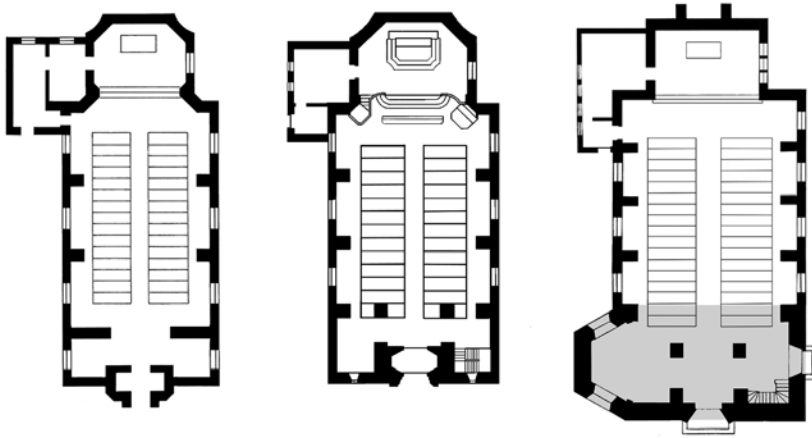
c: Grundrisse: Wiemeringhausen, St. Antonius, 1922 / Eikeloh, St. Johannes Baptist, 1924-25 / Amecke, St. Hubertus, 1932. Zeichnungen: Verf.
